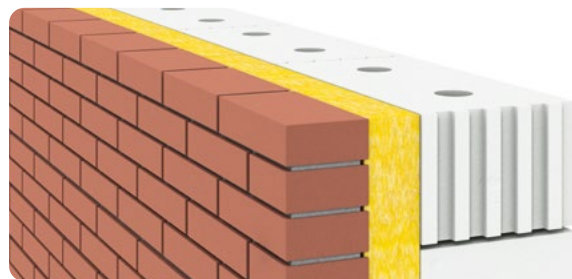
Ausführung mit Wärmedämmung (Kerndämmung)
